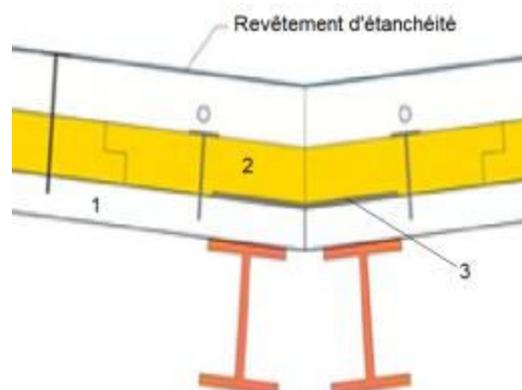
Principe de jointoiment du procédé Stisolétanch® Protect avec élément porteur tôle d'acier nervurée, sur appui double de noue traditionnelle
